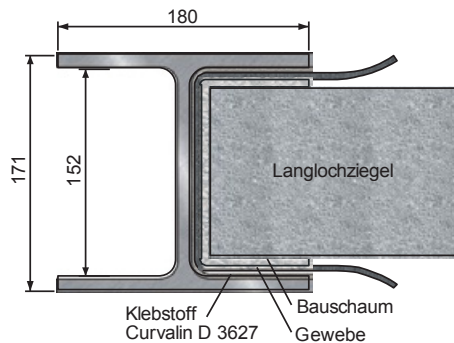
Stützendetail des Mauerwerksanschlusses an die HE-A Profile
